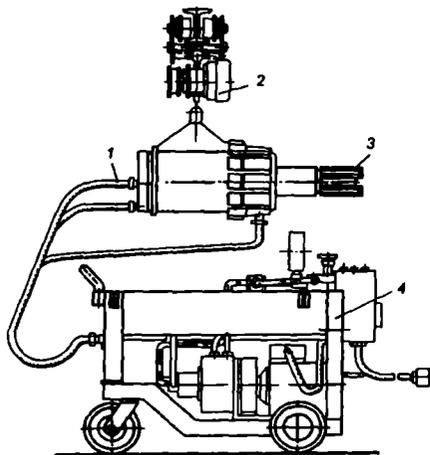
Устройство для натяжения арматуры СМЖ-738:
